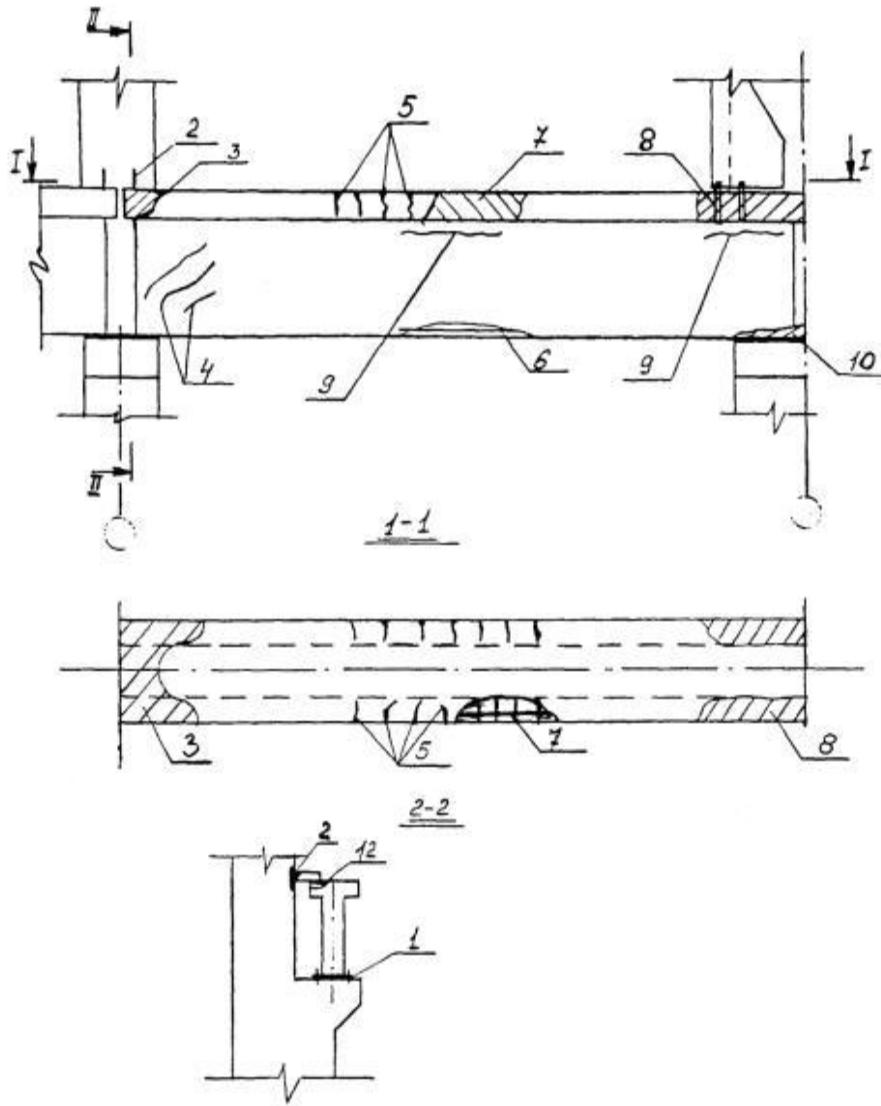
Дефекты железобетонных подкрановых балок
